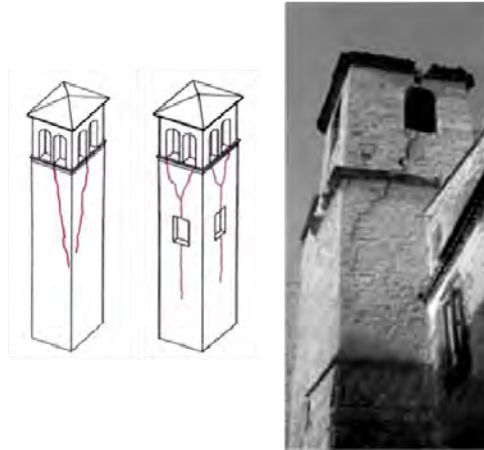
Mecanismo 27 – Fissuração da torre sineira [Curti *et al.*, 2007]
